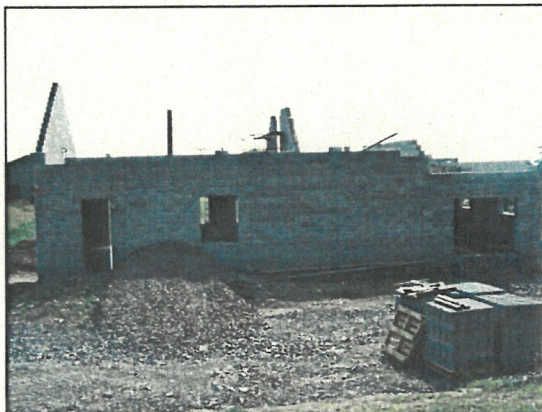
Maison en cours de construction au sein de « Les Poirets ».
